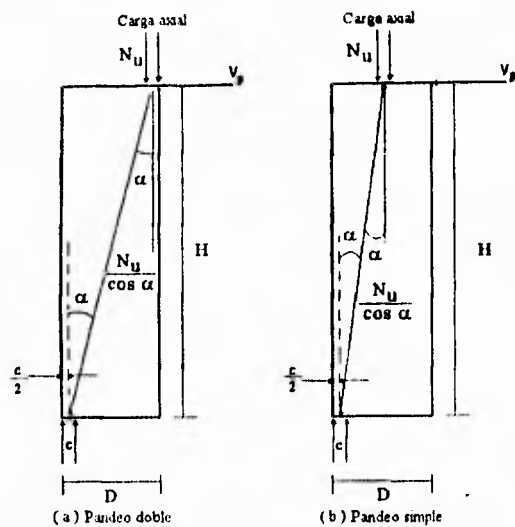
Contribución del concreto y el acero de refuerzo en la columna (Mecanismo de arco)
